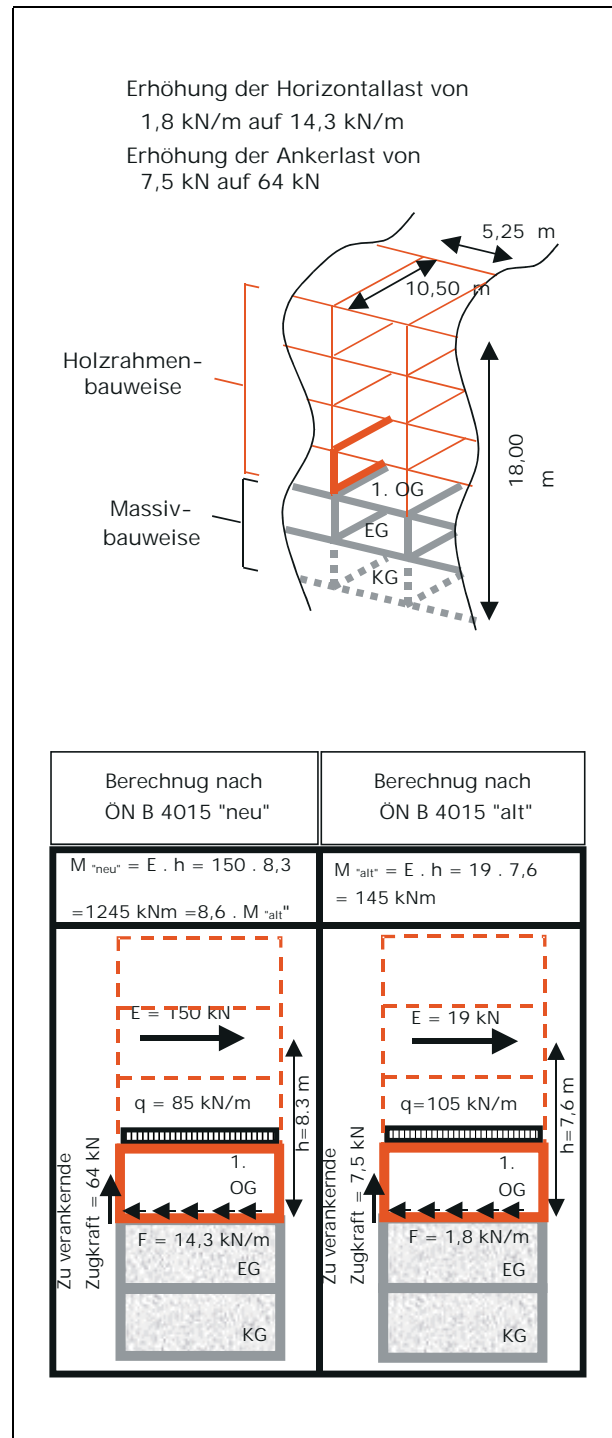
Vergleich der Belastungen im Erdbebenfall pro Querschotte an einem Fallbeispiel: Schottenbauweise mit nach beiden Seiten offenen Fassadenflächen. Abstand der Querschotten: 5,25 m, Gebäudetiefe: 10,50 m
